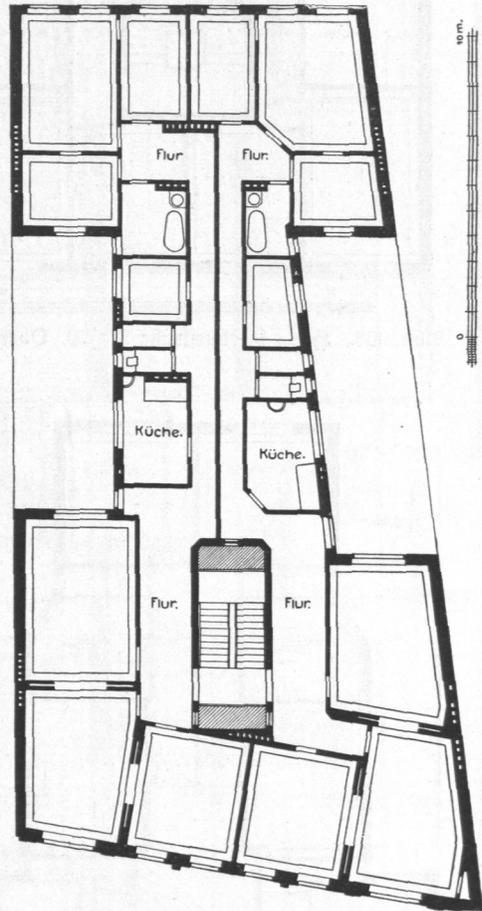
Haus Grindelallee Nr. 78/80, Obergeschoß.
